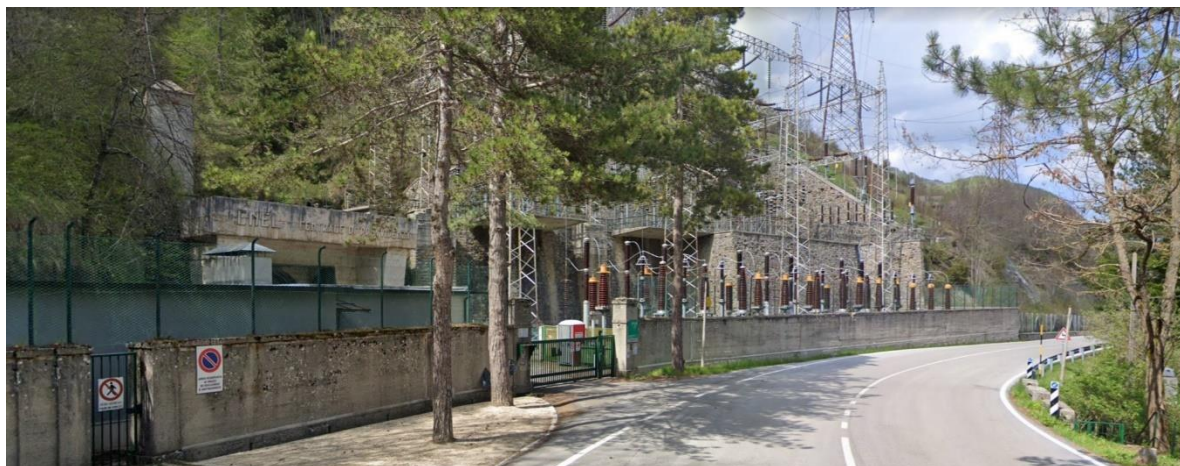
Camera paratoie sulla galleria idraulica di restituzione a lago
